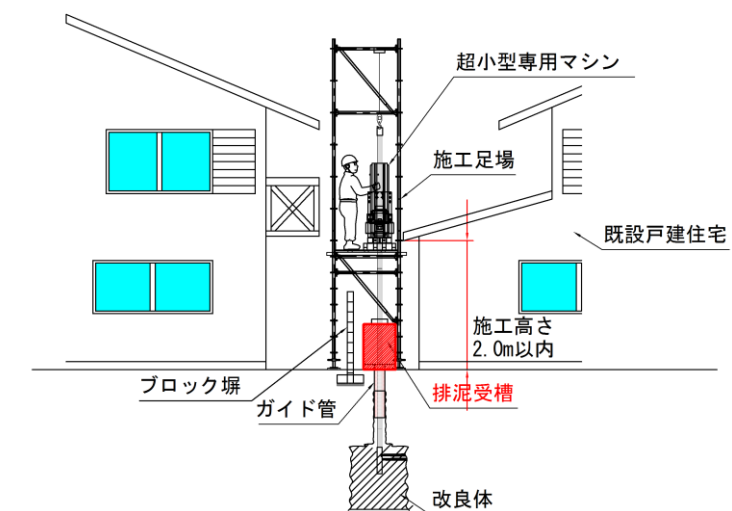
排泥受槽を設置した施工例(施工足場併用時の例)
